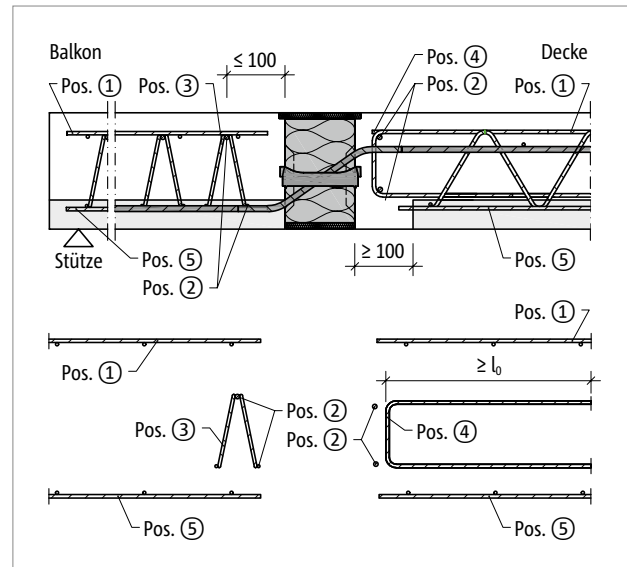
Schöck Isokorb® XT Typ QL-V5 bis V11 Bauseitige Bewehrung mit Gitterträger
